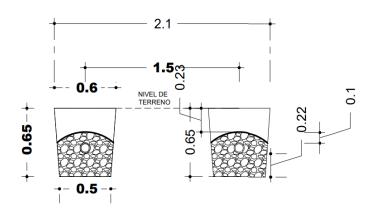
Dimensiones y detalle de las Zanjas de infiltración.
